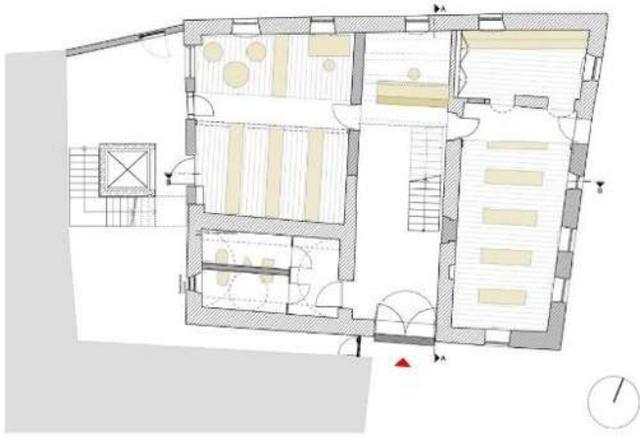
Planta Casa Jura. Tomada de Archdaily.
